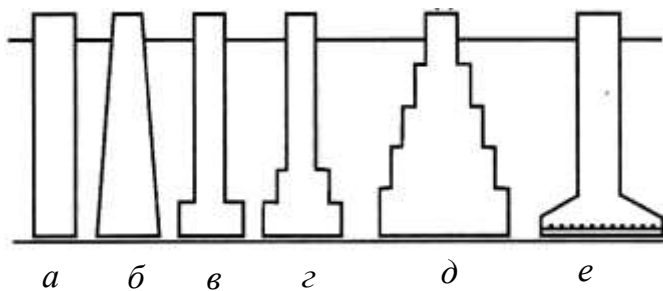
Форми поперечних перерізів стрічкових фундаментів будівель:
